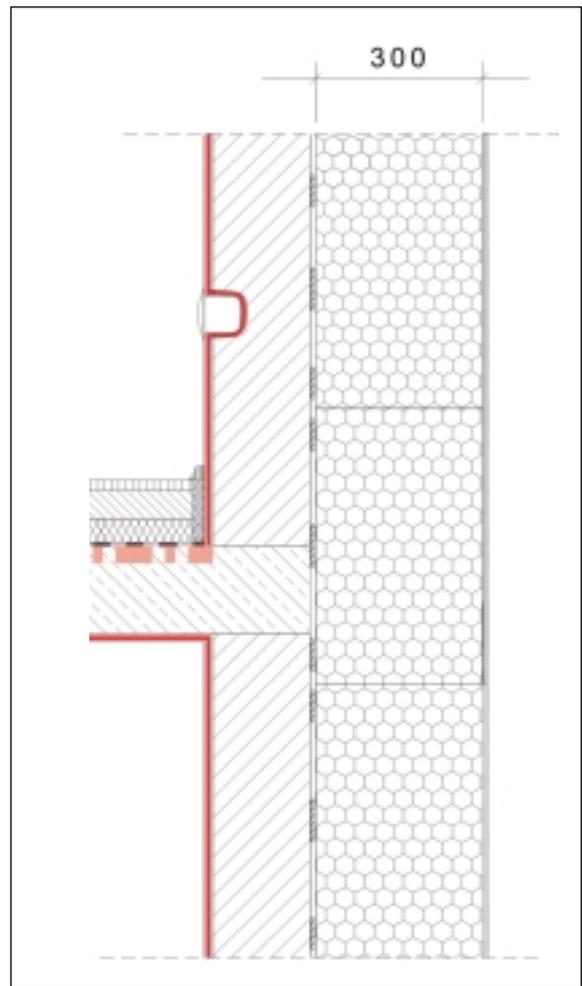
Anschlussdetail Betondecke an massive Wand mit WDVS. Hier ist die Wärmebrückenwirkung vollständig vernachlässigbar ($\Psi_a = 0$), weil die Dämmschicht nicht geschmälert wird.
